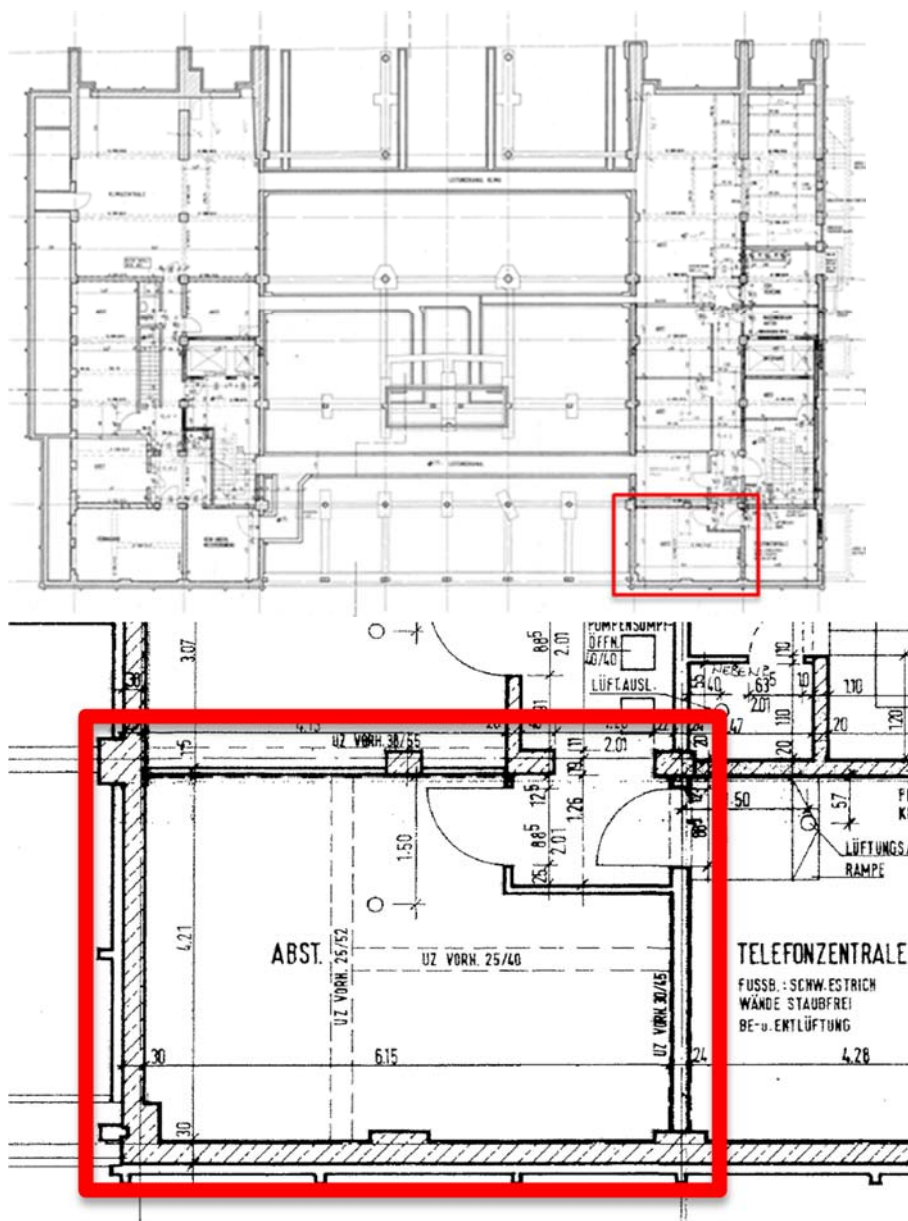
Untersuchungsobjekt, Grundriss Kellergeschoß, Empfangsraum
